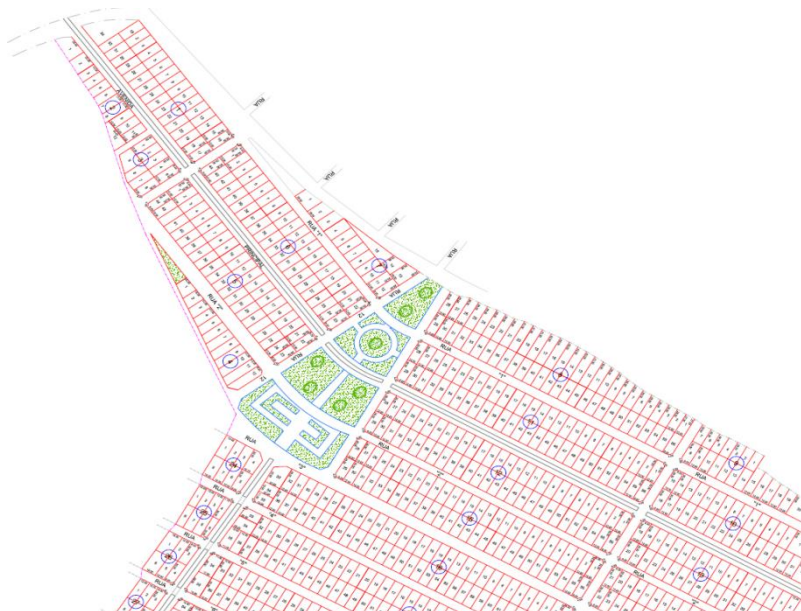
Identificação de Vias e Lotes no entorno do Rio Una na Planta Aprovada do Loteamento Bairro de Anchieta.
